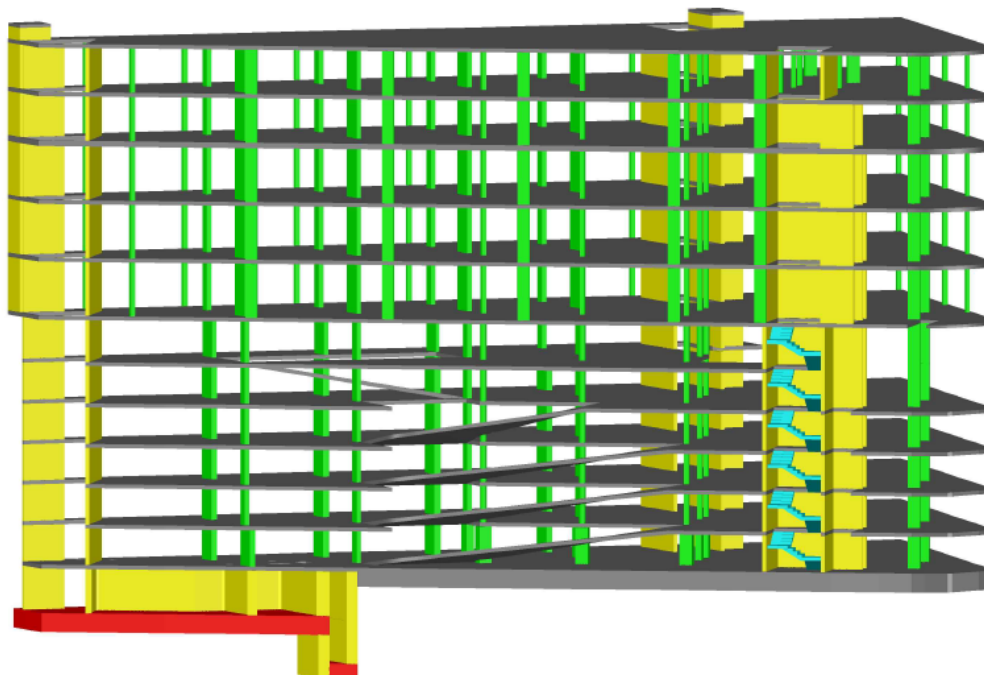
Projeção tridimensional da estrutura do edifício
